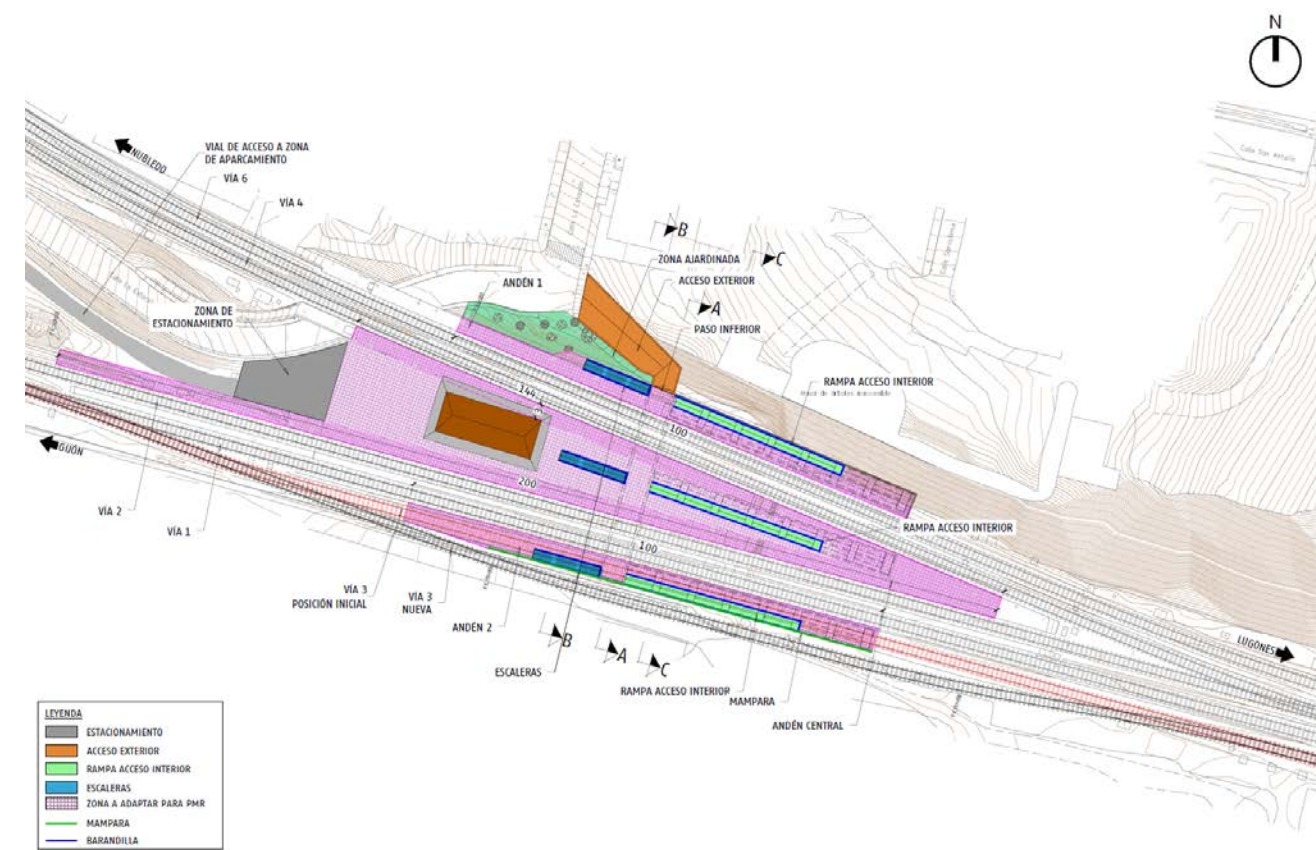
Planta de la alternativa a desarrollar en el Proyecto Constructivo
